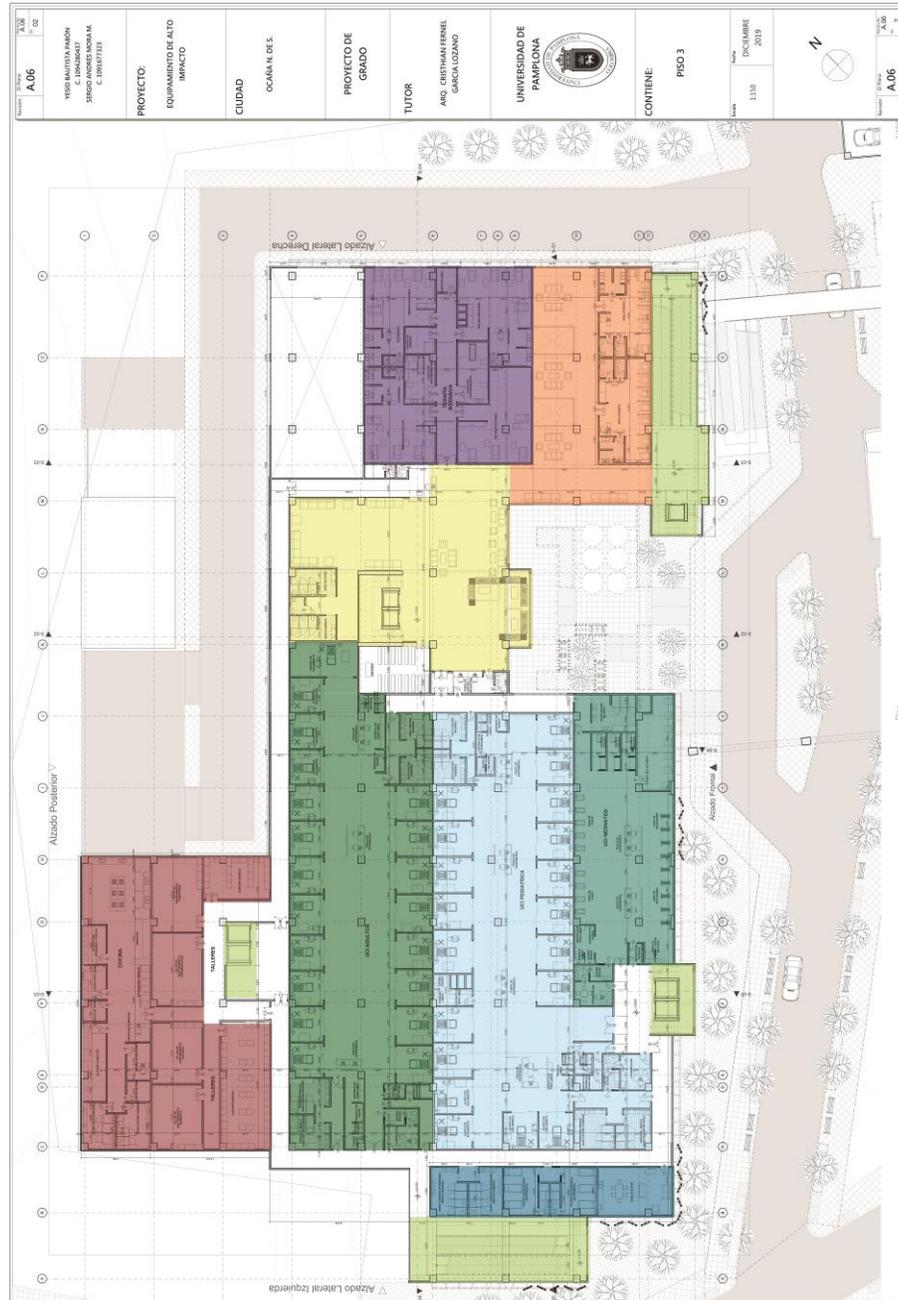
Consulta Externa. Especialidades. (Plano Planta Piso 3)
